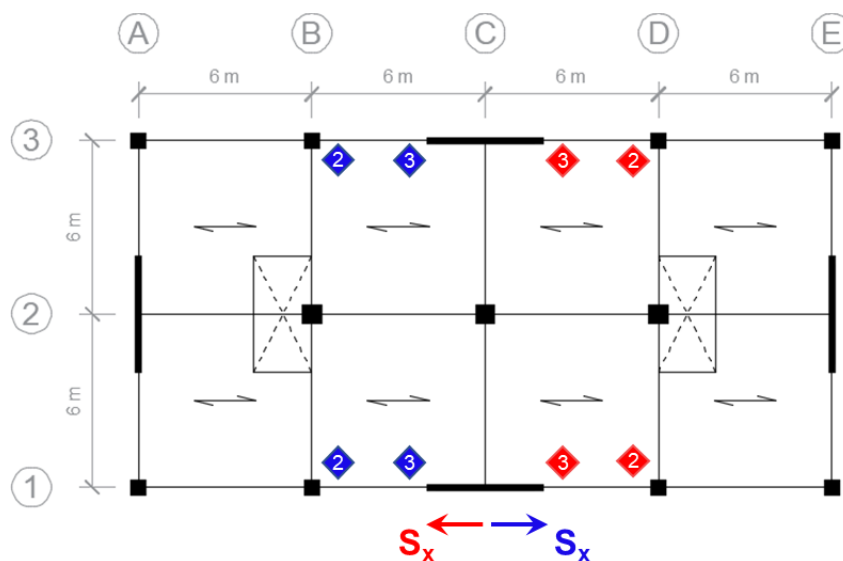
Secciones de las vigas en estudio para la verificación del diseño por corte, correspondiente la fuerza sísmica en la dirección X
